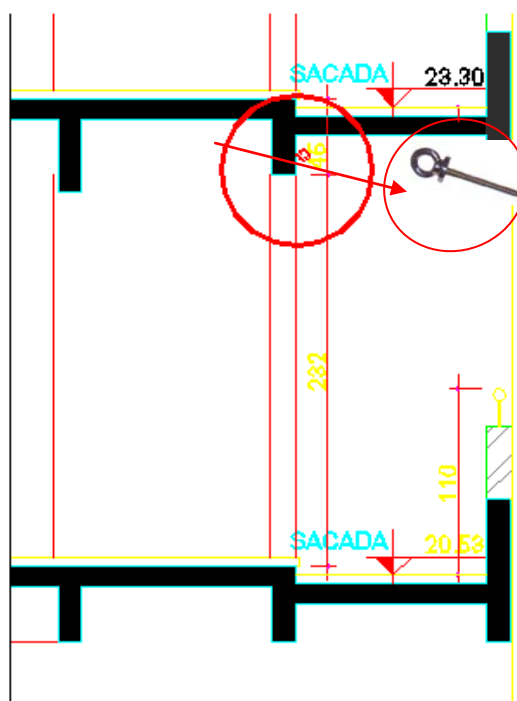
Colocação de ganchos para a execução forros nas sacadas
